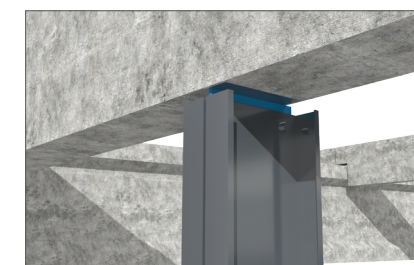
Provedení sloupů opláštění u betonového skeletu
